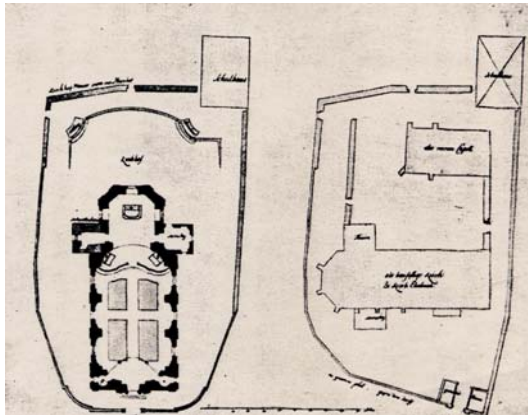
Kirchehrenbach, Entwurf Roppelts
